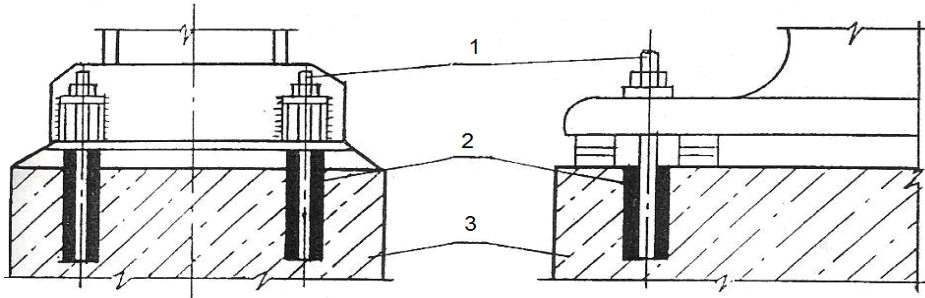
Кріплення обладнання до фундаментів за допомогою клейових анкерів:
